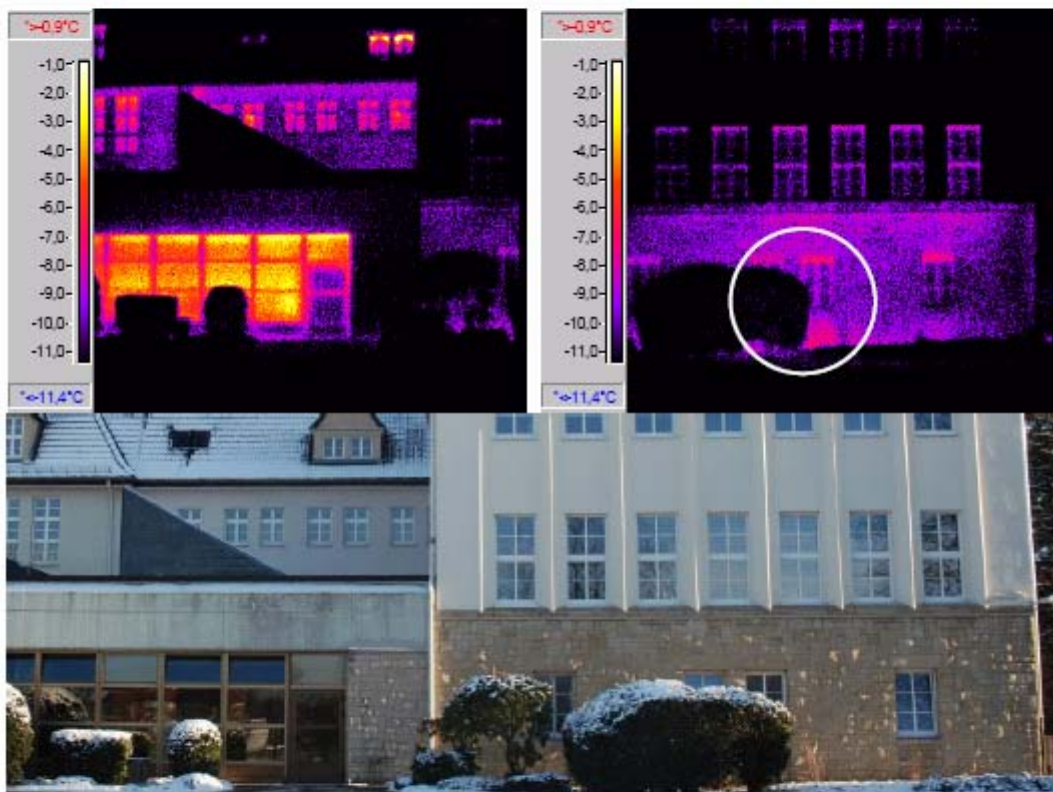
Hauptgebäude mit Flachbau, Ansicht von Nord-Westen
